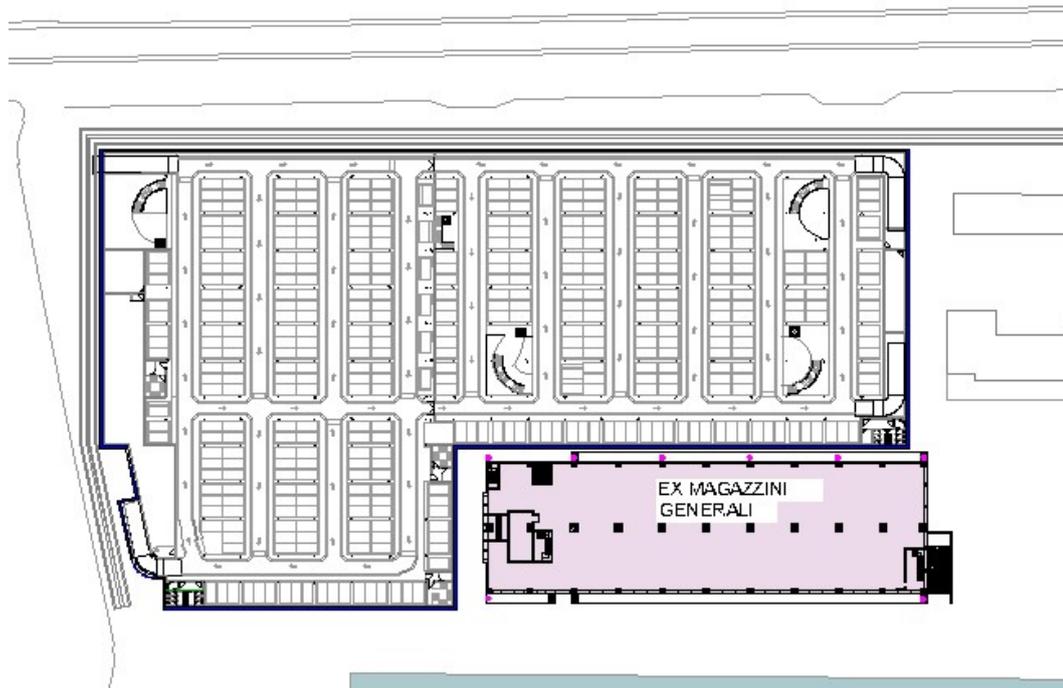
Planimetria di progetto Parcheggio interrato con ubicazioni microprismi
